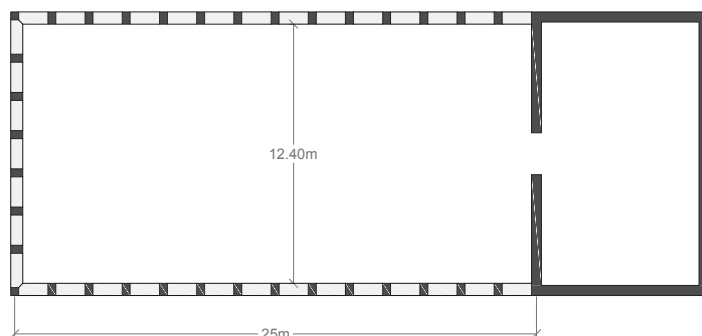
Esquema sistema estructural simplificado Edificio Picasso
